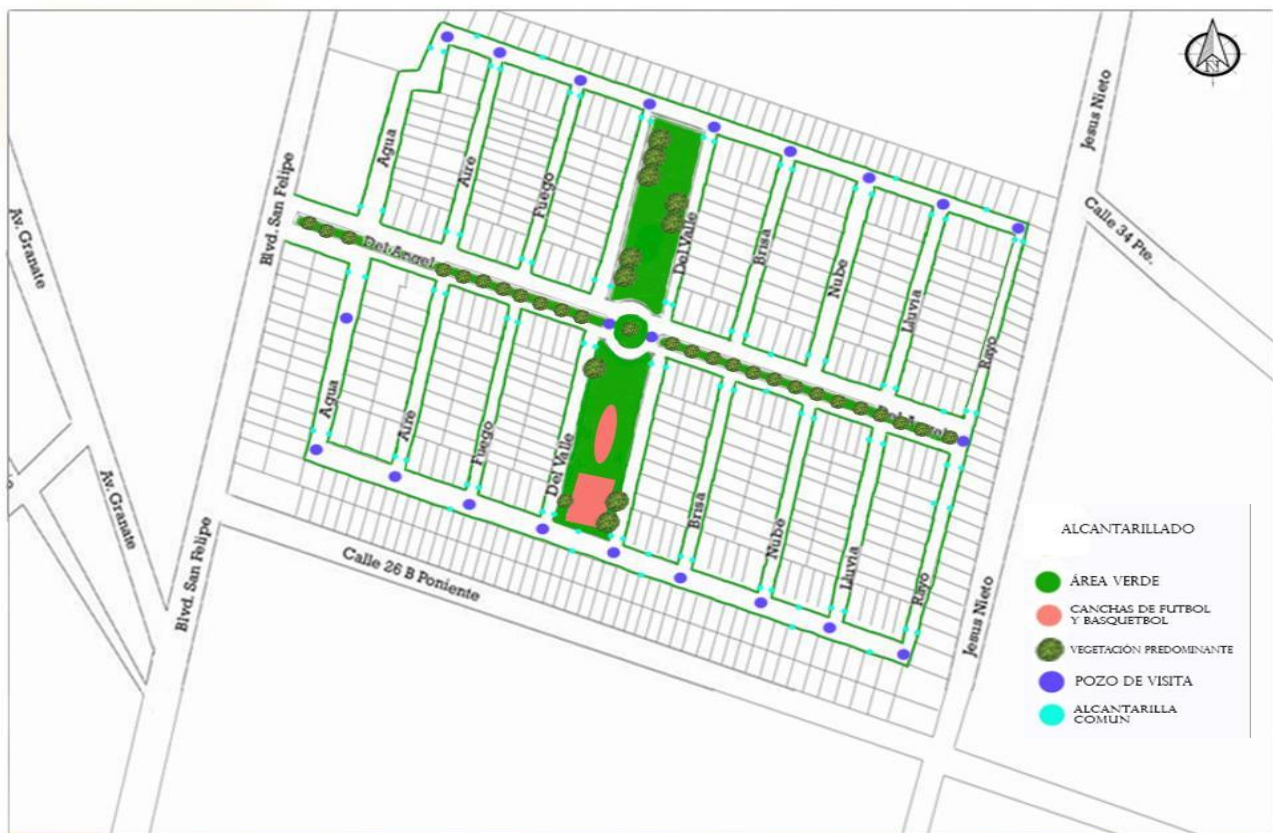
Plano de alcantarillado. (Autoras, 2018)
